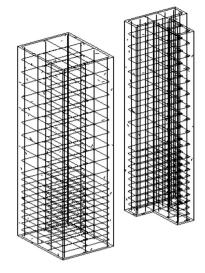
钢筋三维视图 Fig.5 The 3D view of rebar
